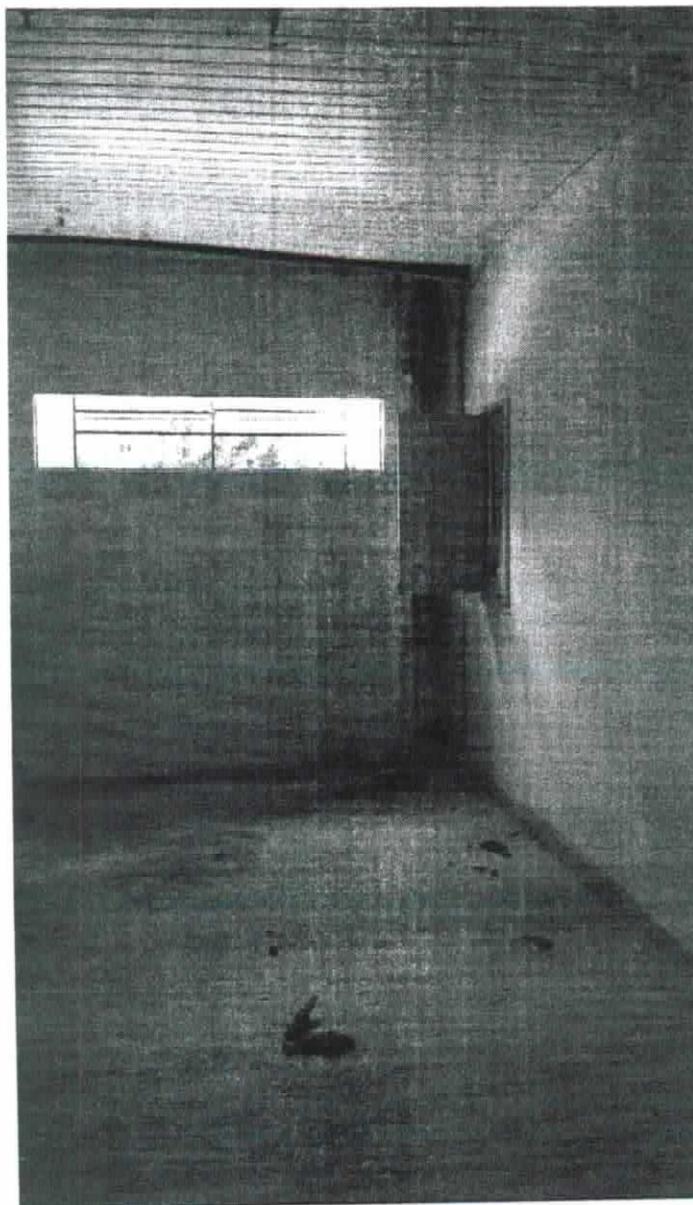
Interior da edificação. Desmoronamento parcial da estrutura de fixação do forro de PVC por meio da infiltração e apodrecimento da estrutura em madeira.
